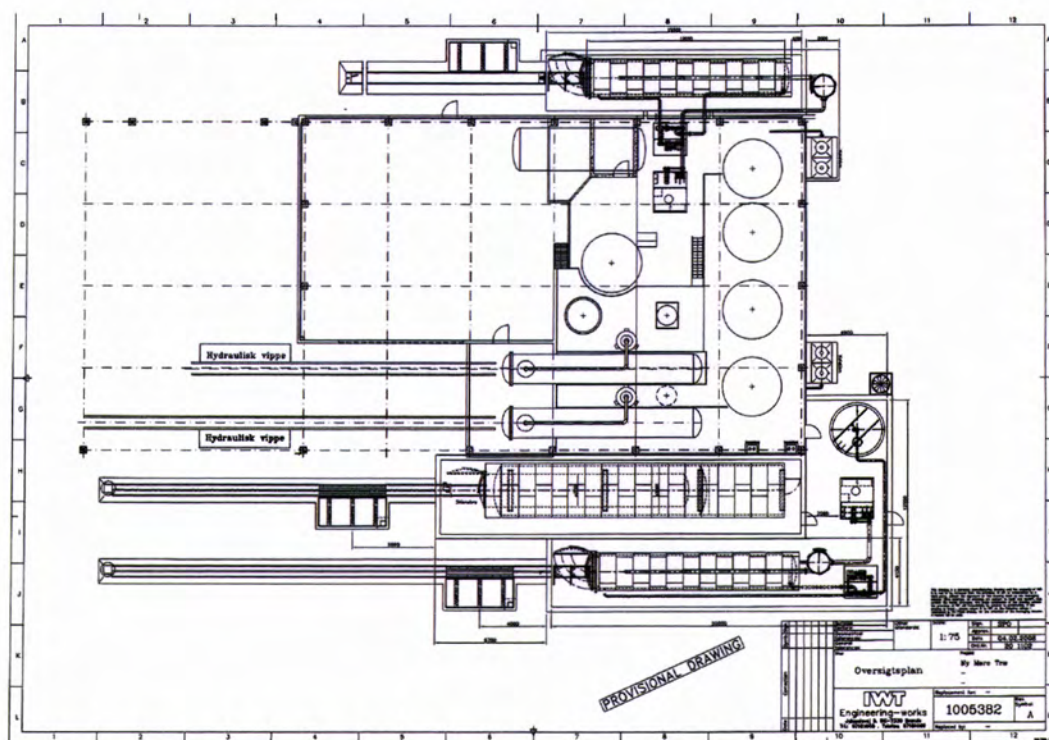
Ny royallinje inklusive lagertanker er i sin helhet plassert på tett betonggulv omgitt av betongkant med høyde ca. 15 cm
